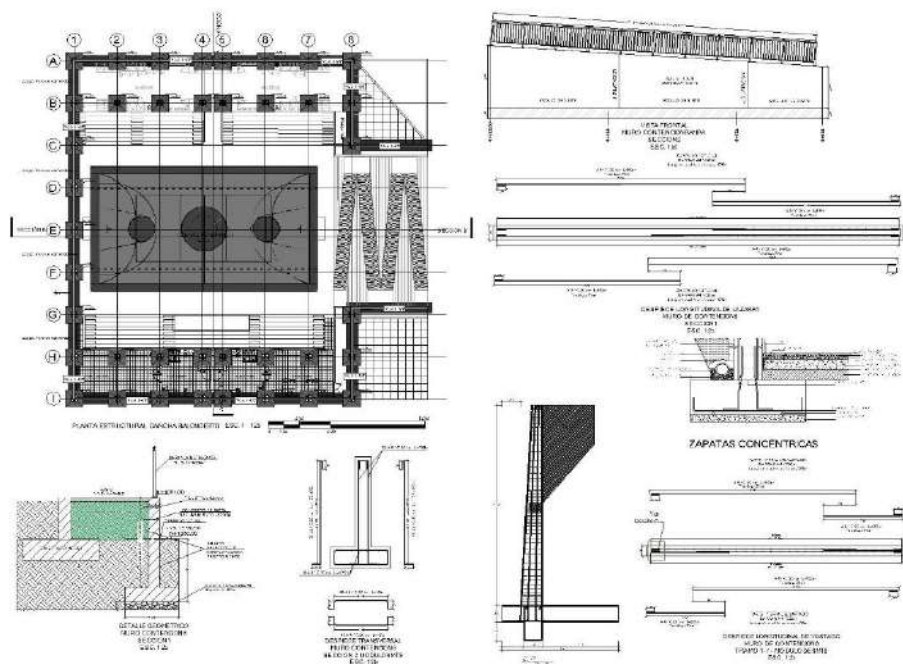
Planimetría estructural cancha de baloncesto. Fuente: Elaboración propia 2021.
